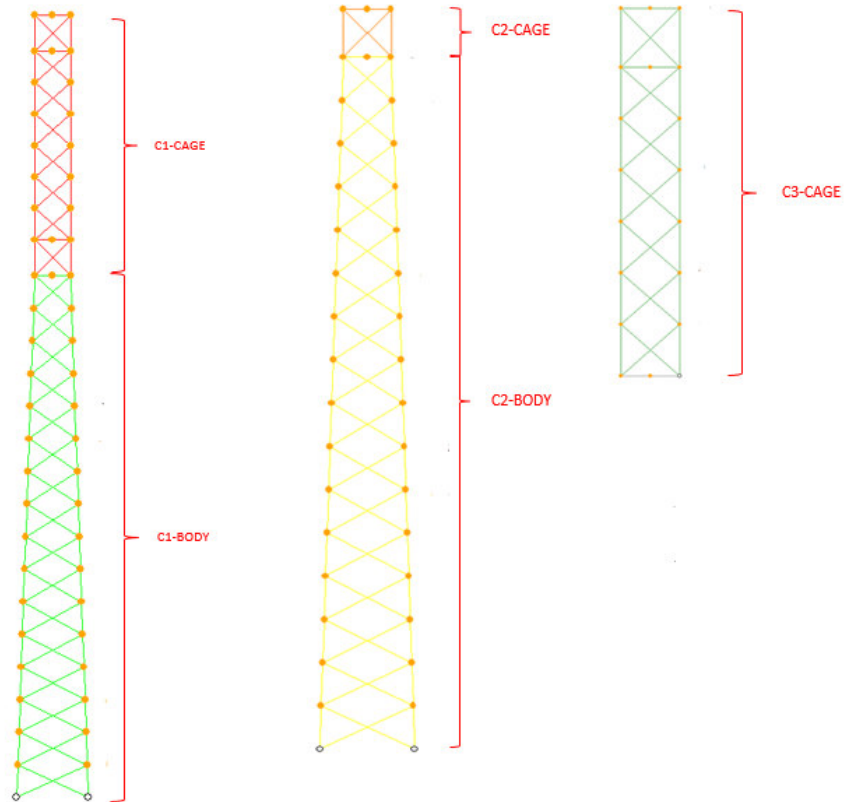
Seccionamiento en columnas tipo 1, 2 y 3
